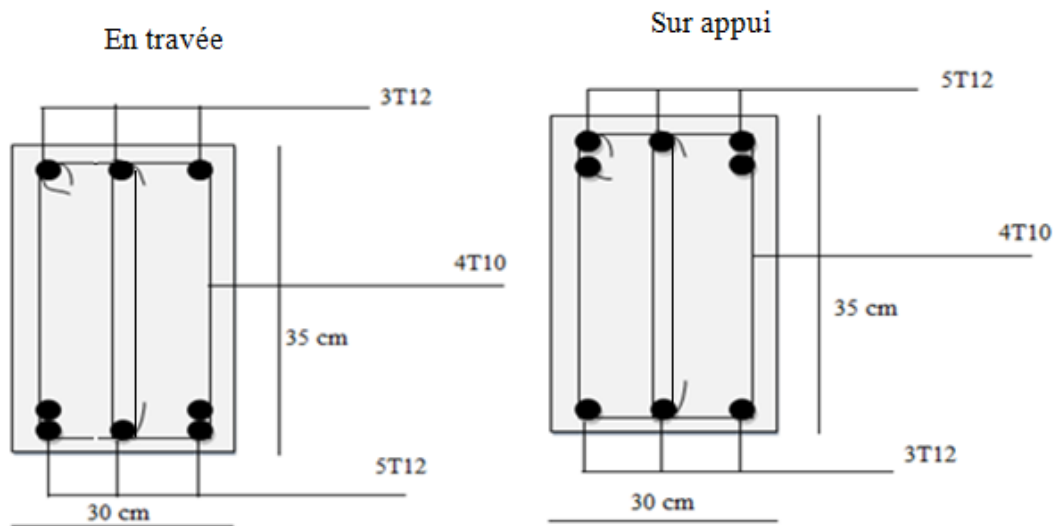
Ferrailage des poutres non porteuses terrasse, centre commerciale sous-sol
